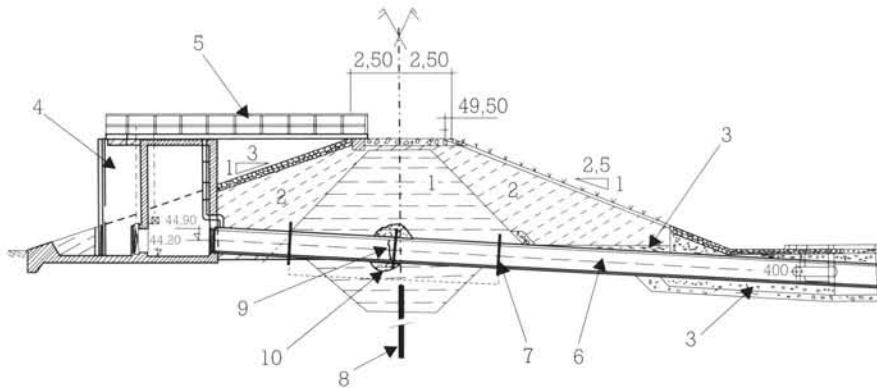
Coupe transversale du barrage de LA PRADE (Gironde) dans l'axe de prise et de vidange.
